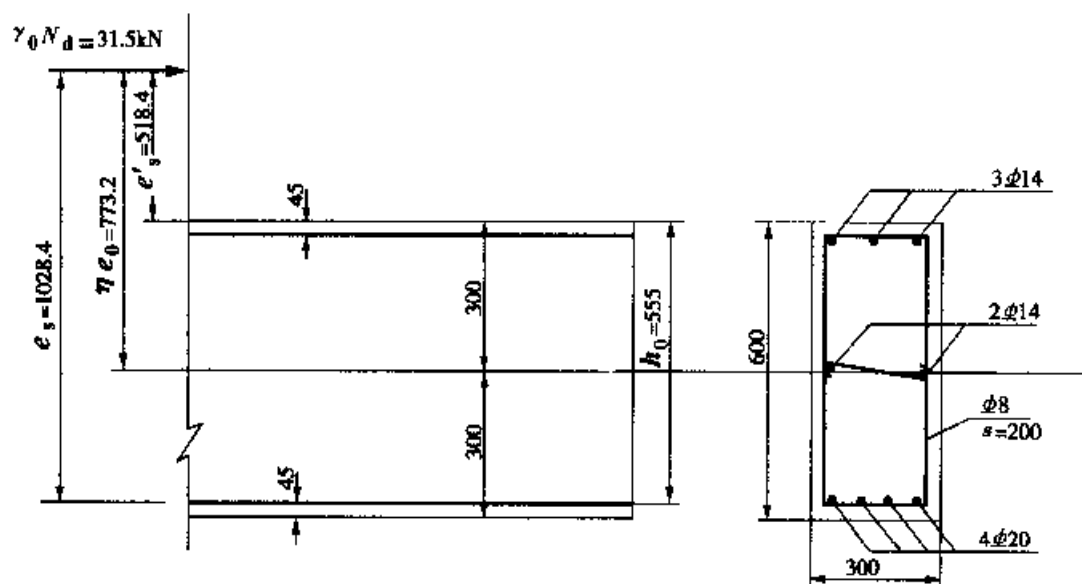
偏心受压构件计算简图及配筋(尺寸单位:mm)
